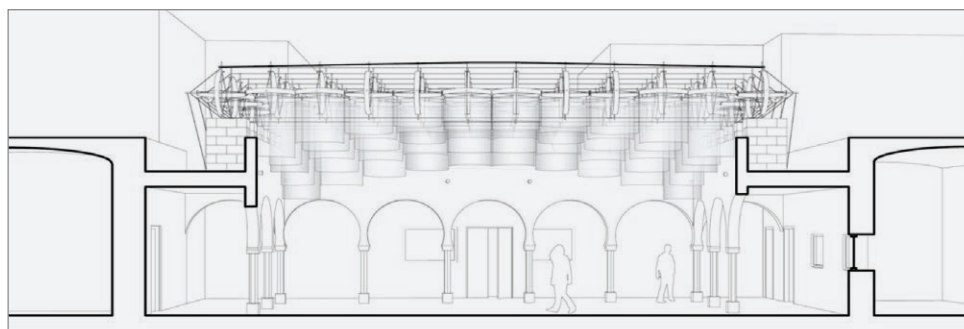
Coupe transversale du patio, illustrant le bâtiment existant, le système structural tenségritaire et les protections textiles. (Source : de l'auteur)
